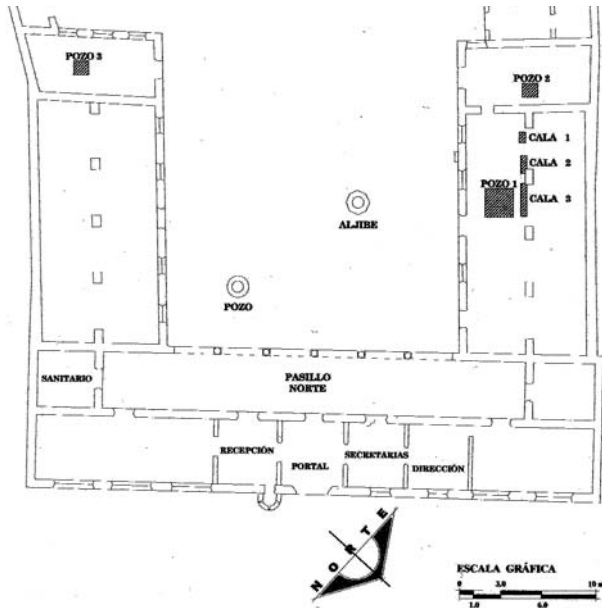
Planta arquitectónica del inmueble al iniciar los trabajos de liberación y previos a la restauración. Archivo Centro INAH-Campeche.
